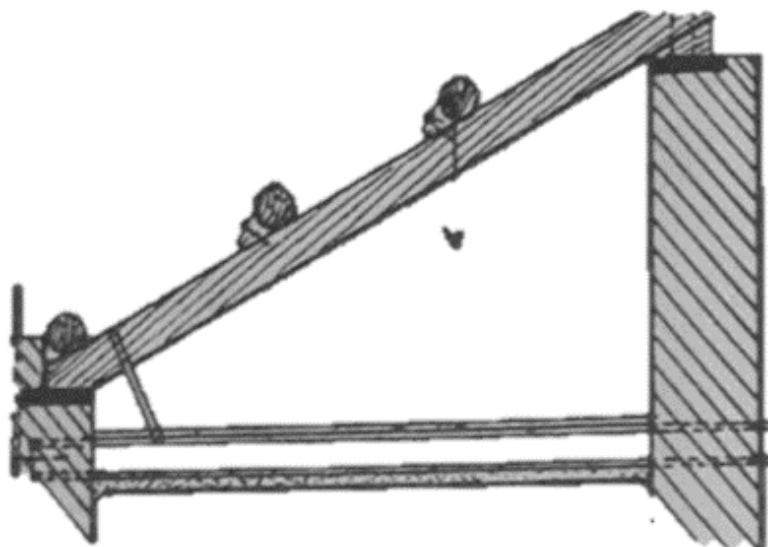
Puntone appoggiato ad angolo retto sulla muratura con gattello e lastre di pietra (Vivarelli 1913, p. 404).
